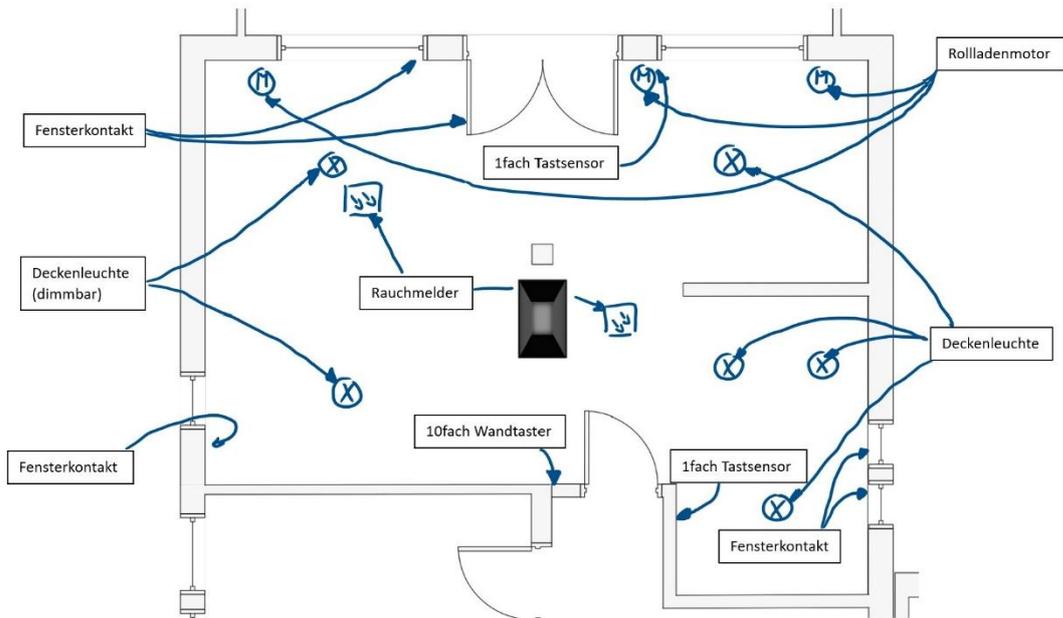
Grundriss Wohnzimmer/Esszimmer/Küche mit Geräten
